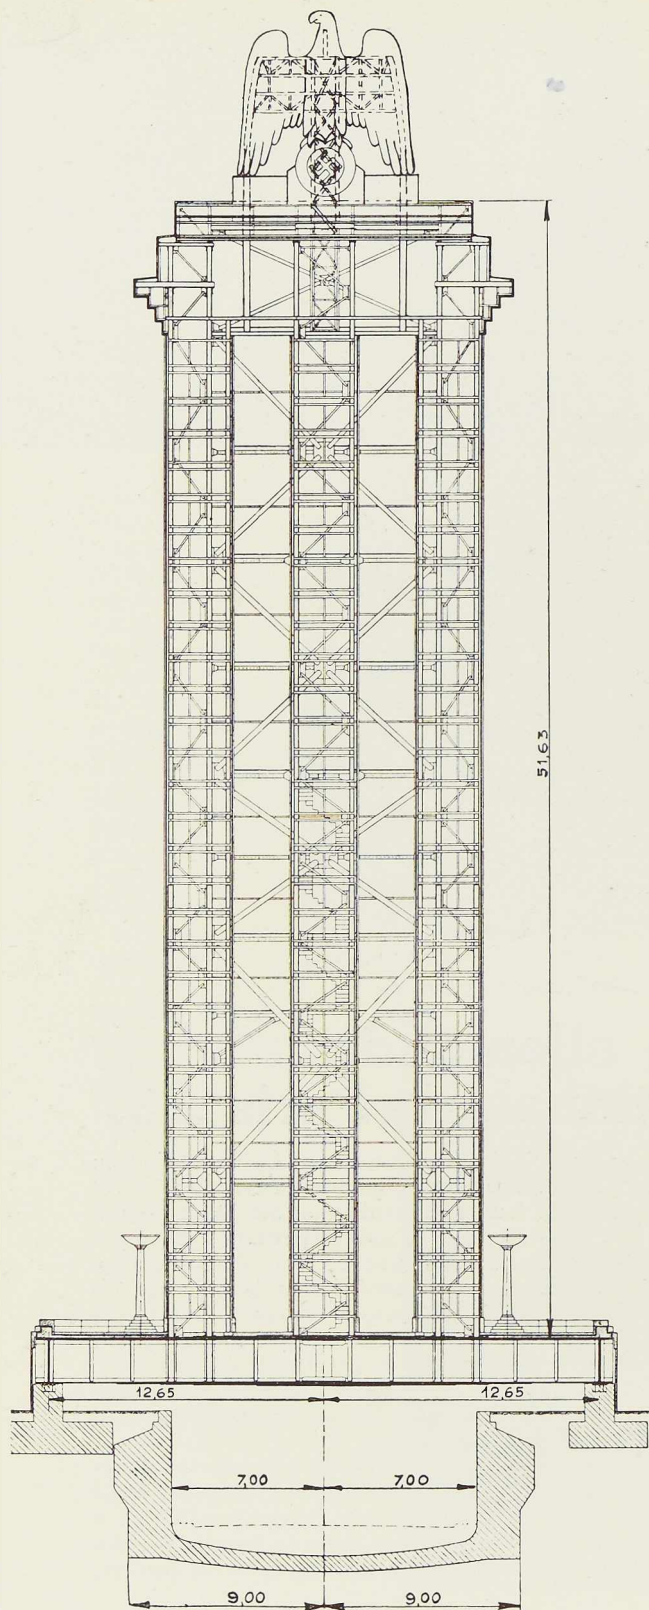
Coupe transversale dans la tour, montrant le passage souterrain au-dessus duquel elle est construite.
